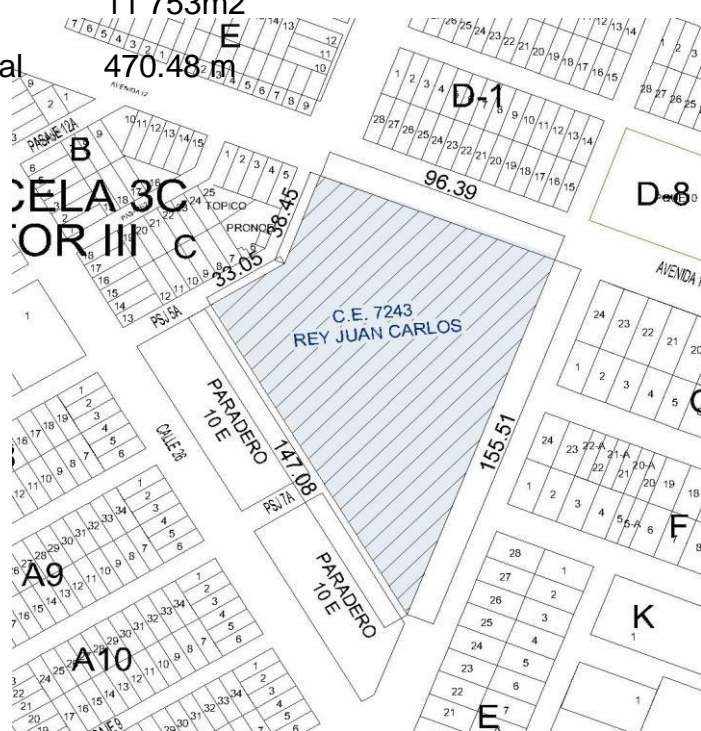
Ubicación del terreno. Fuente: Elaboración propia.
